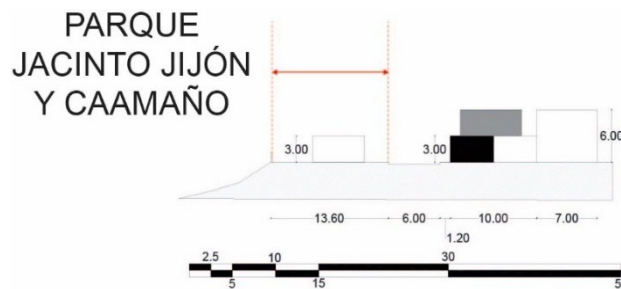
Corte transversal P. Jacinto Jijón y Caamaño
